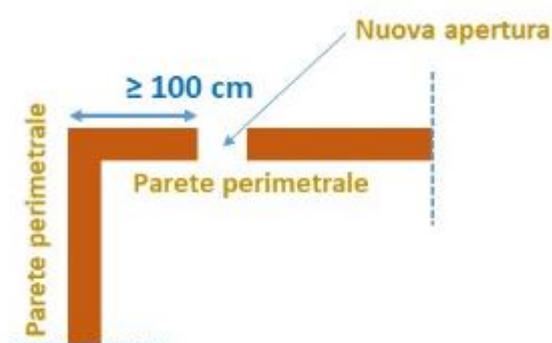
Dettaglio apertura di un vano in una parete perimetrale
